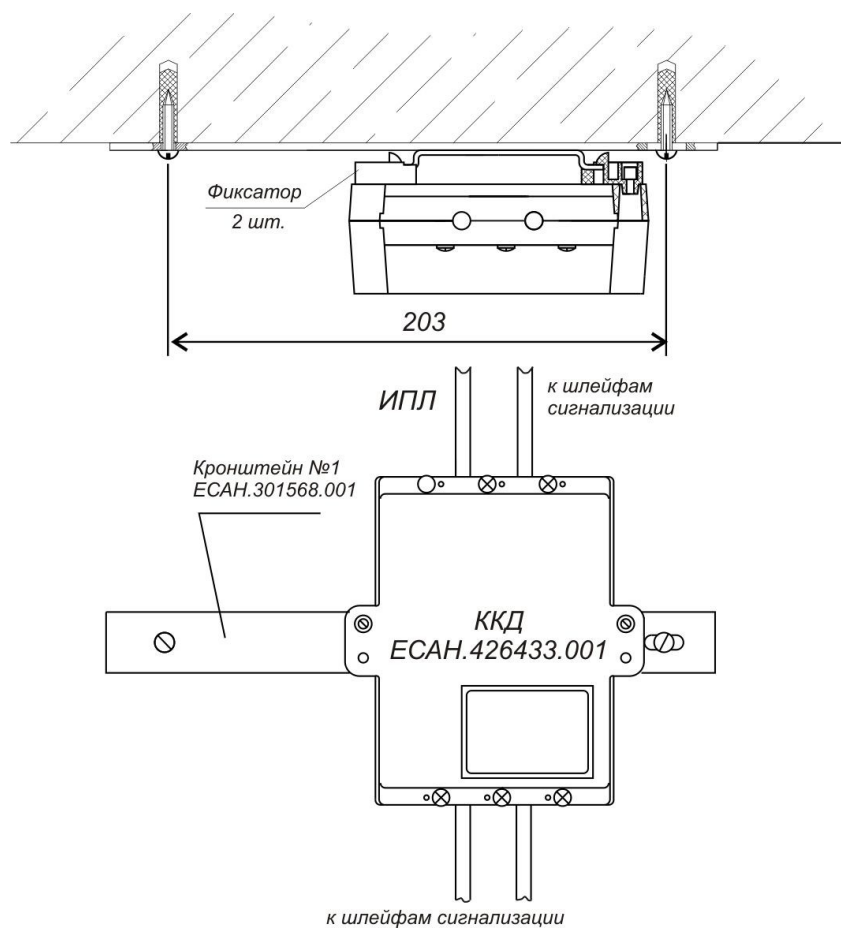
Установка ККД и тройниковой коробки на кронштейн №1
